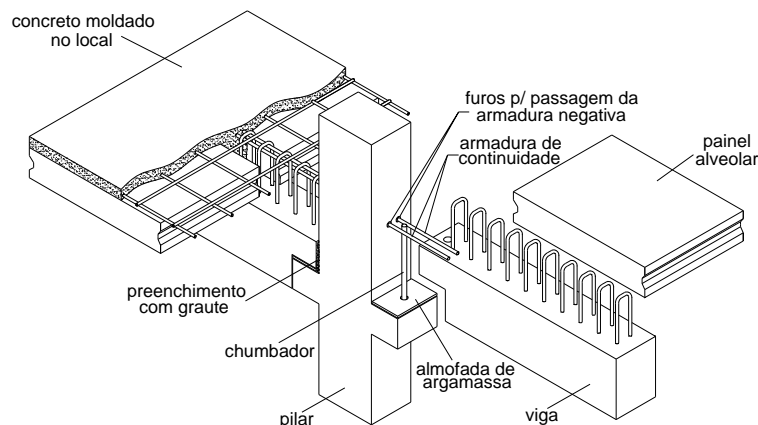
Ligação viga-pilar semi-rígida com pino chumbador [BALDISSERA (2006)]
